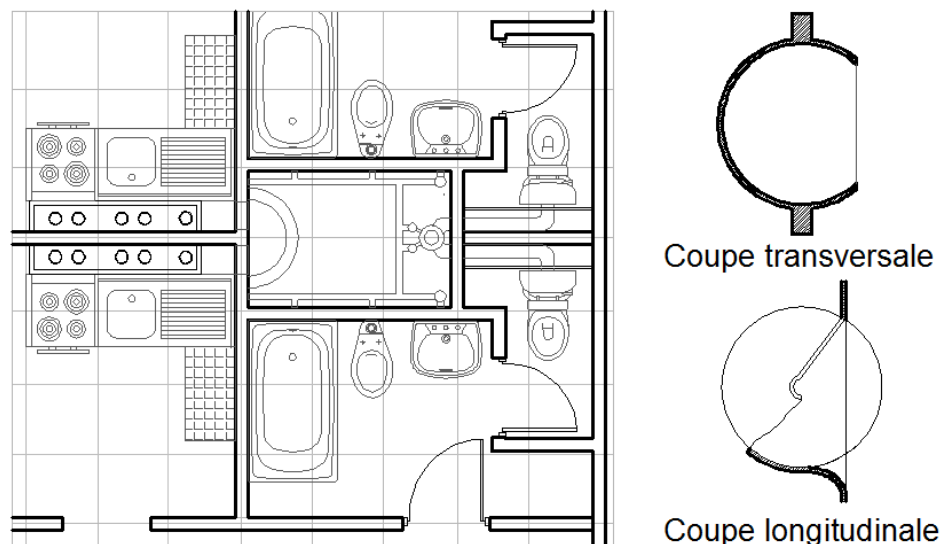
19: Vue en plan de la conduite d'évacuation d'un plan type et coupe transversale et longitudinale du dispositif.
